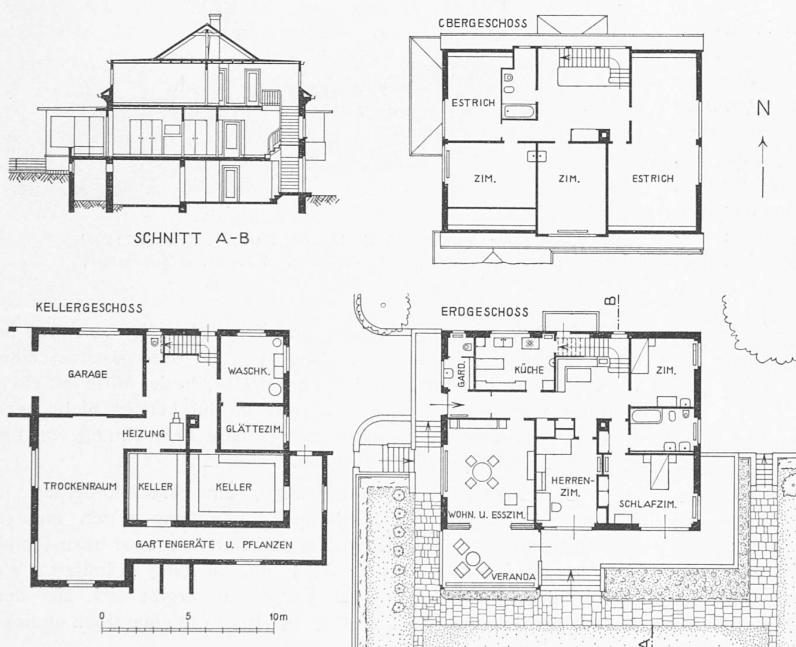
Grundrisse und Schnitt. — Masstab 1 : 400.
